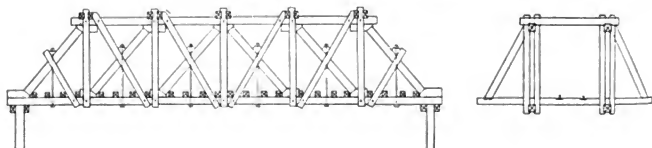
u. 220. Holzene Fachwerksbrücke.
